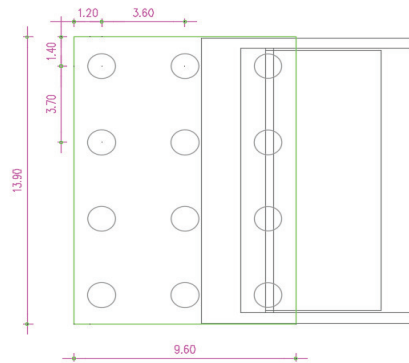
Vue en plan de la semelle sur pieux de la culée.
